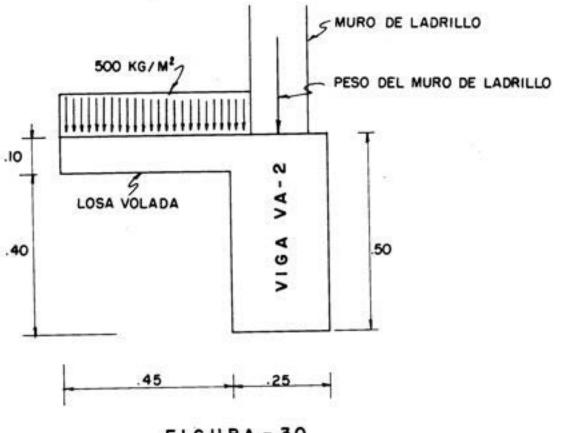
CARGAS SOBRE LA VIGA VA - 2
